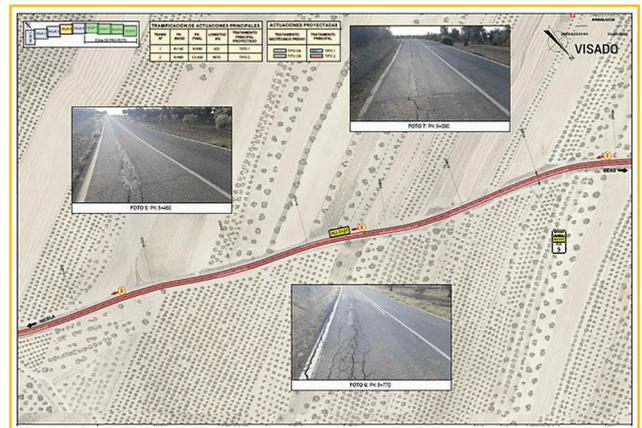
Planimetria del tratto stradale interessato della strada provinciale HU-3107
